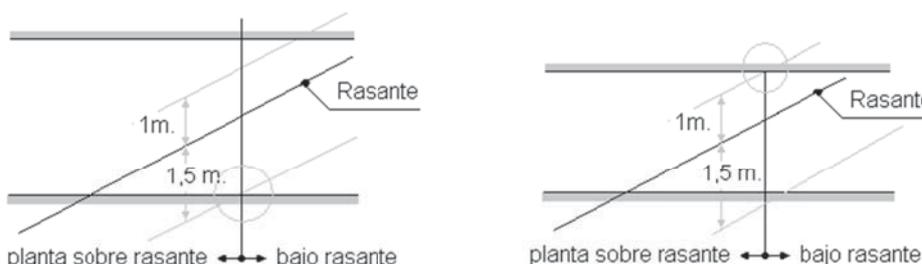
Determinación de planta sobre y bajo rasante
